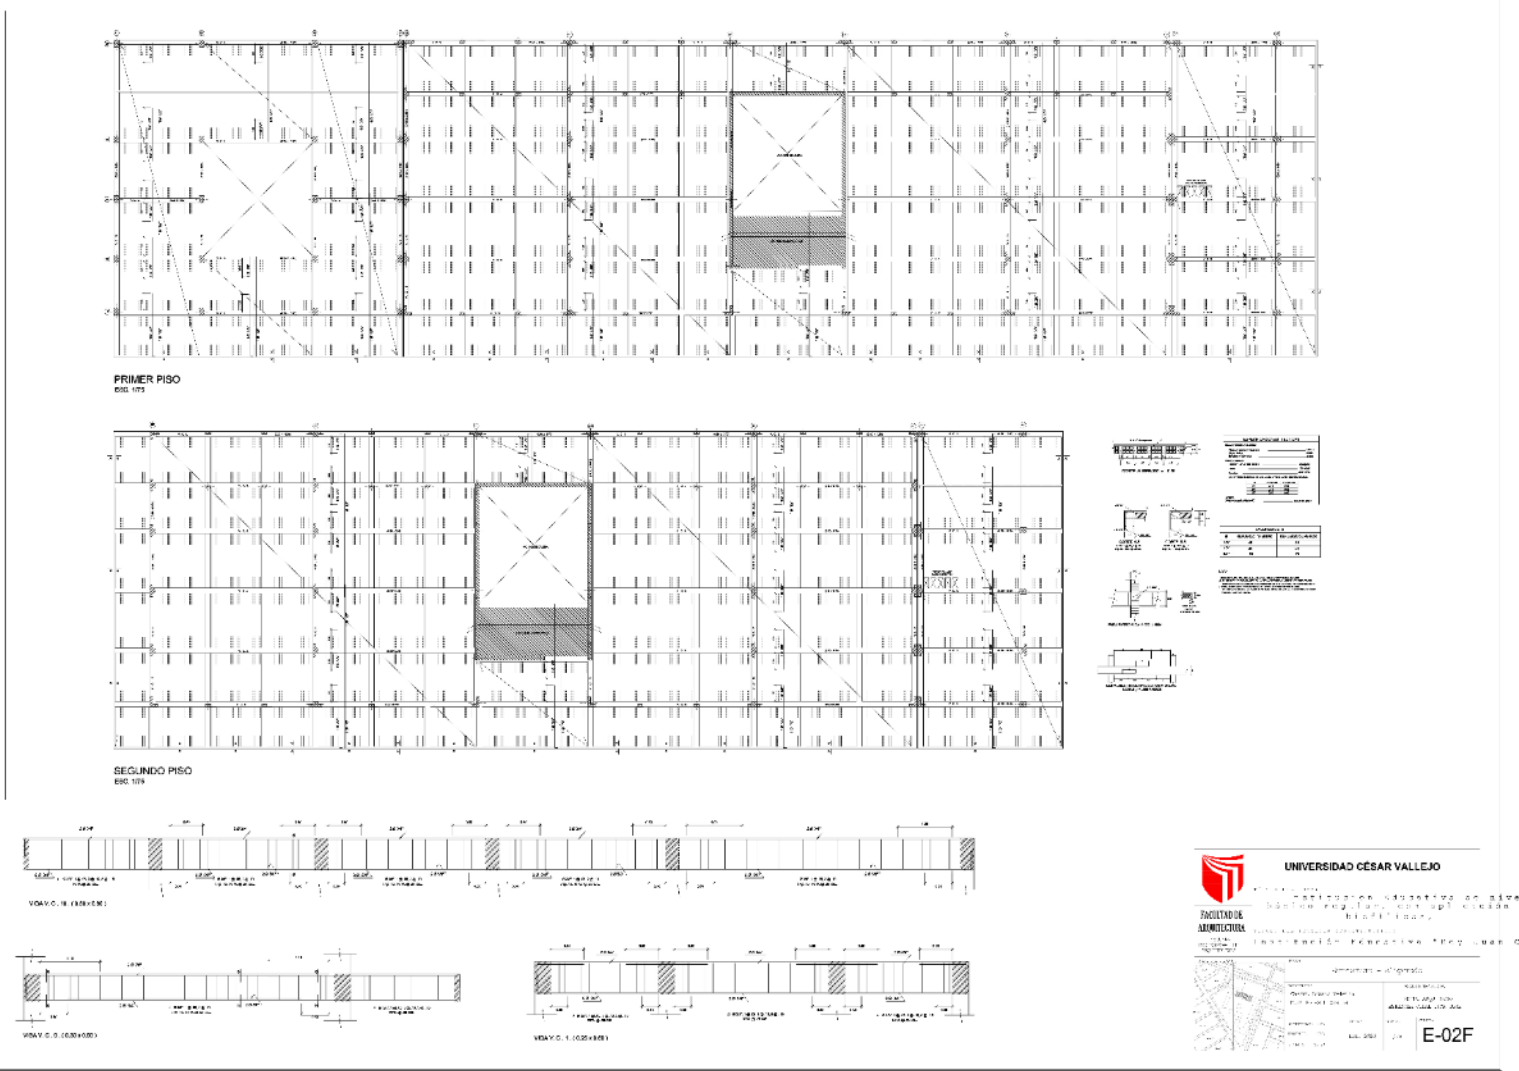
Plano de losa aligerada bloque "F", Fuente: elaboración propia
